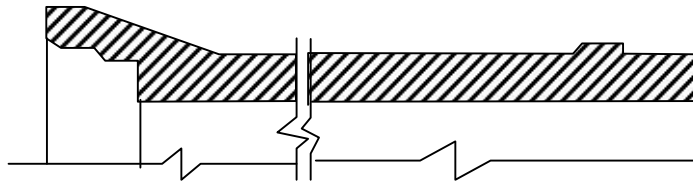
Поздовжній переріз залізобетонної труби
